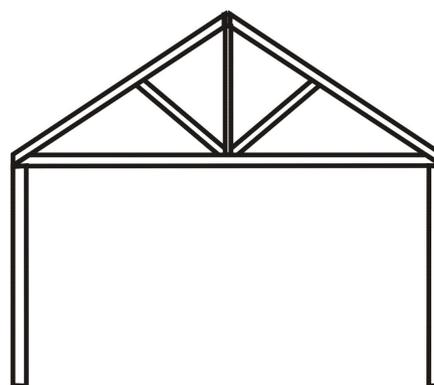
Telhado em sistema de tesouras ou *Truss roof*.
